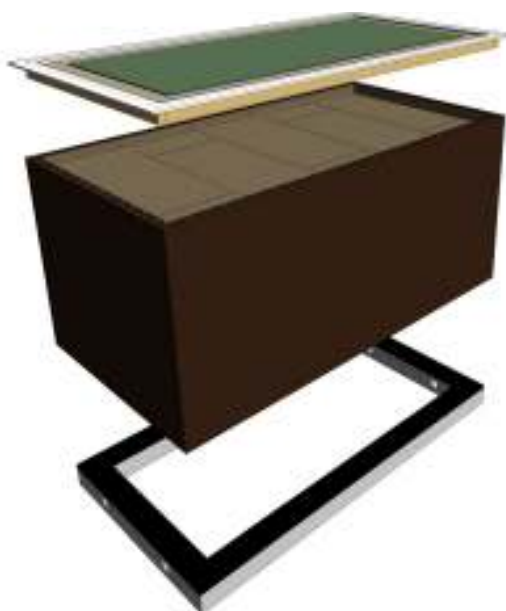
Conjugação da cobertura ajardinada com o módulo tipo.
